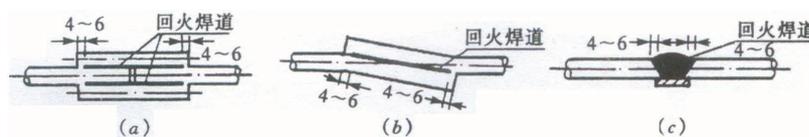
钢筋负温电弧焊回火焊道示意图
